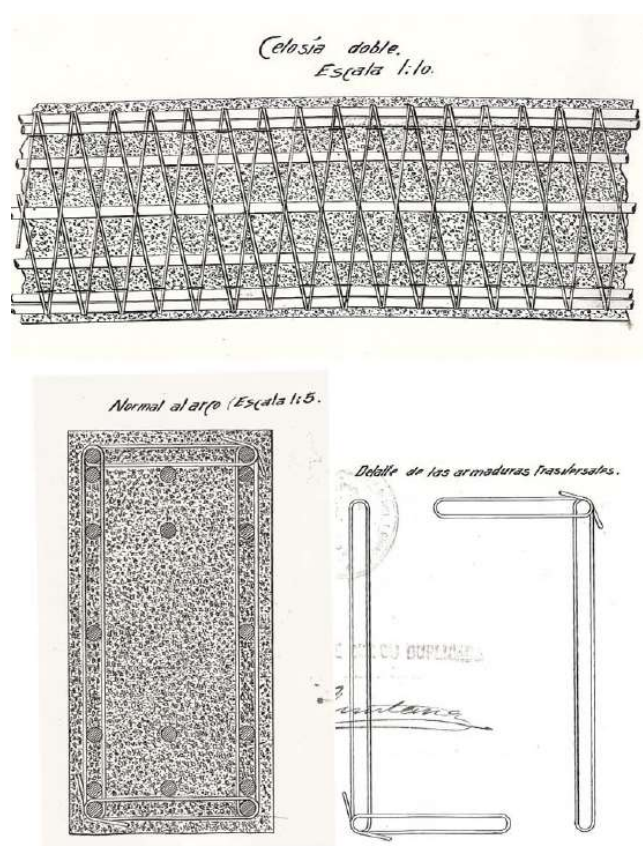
, patente de arcos de hormigón armado de Gabriel Rebollo, de la tesis de A. Burgos.
